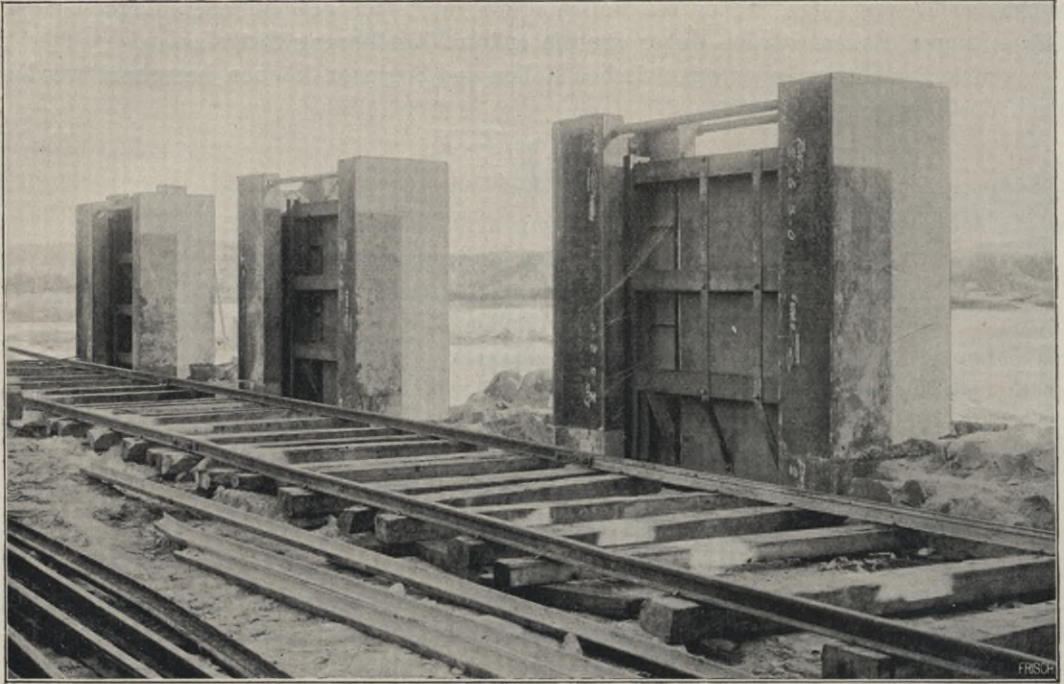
Einbau der Rollschütze an der Staumauer bei Assuan.
